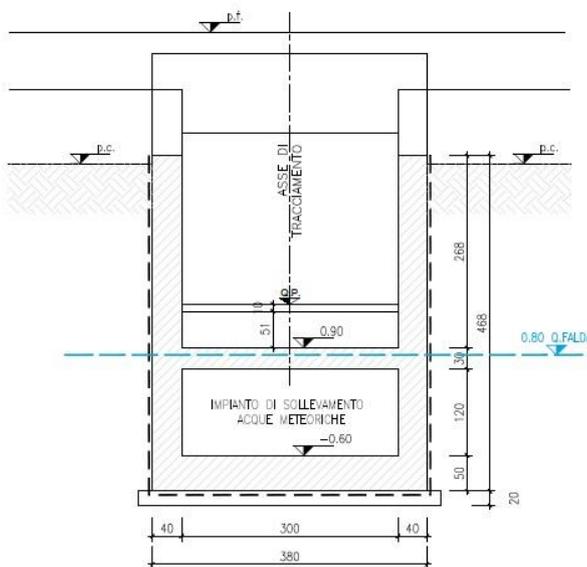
Sezione trasversale muro a U lato SS.1
